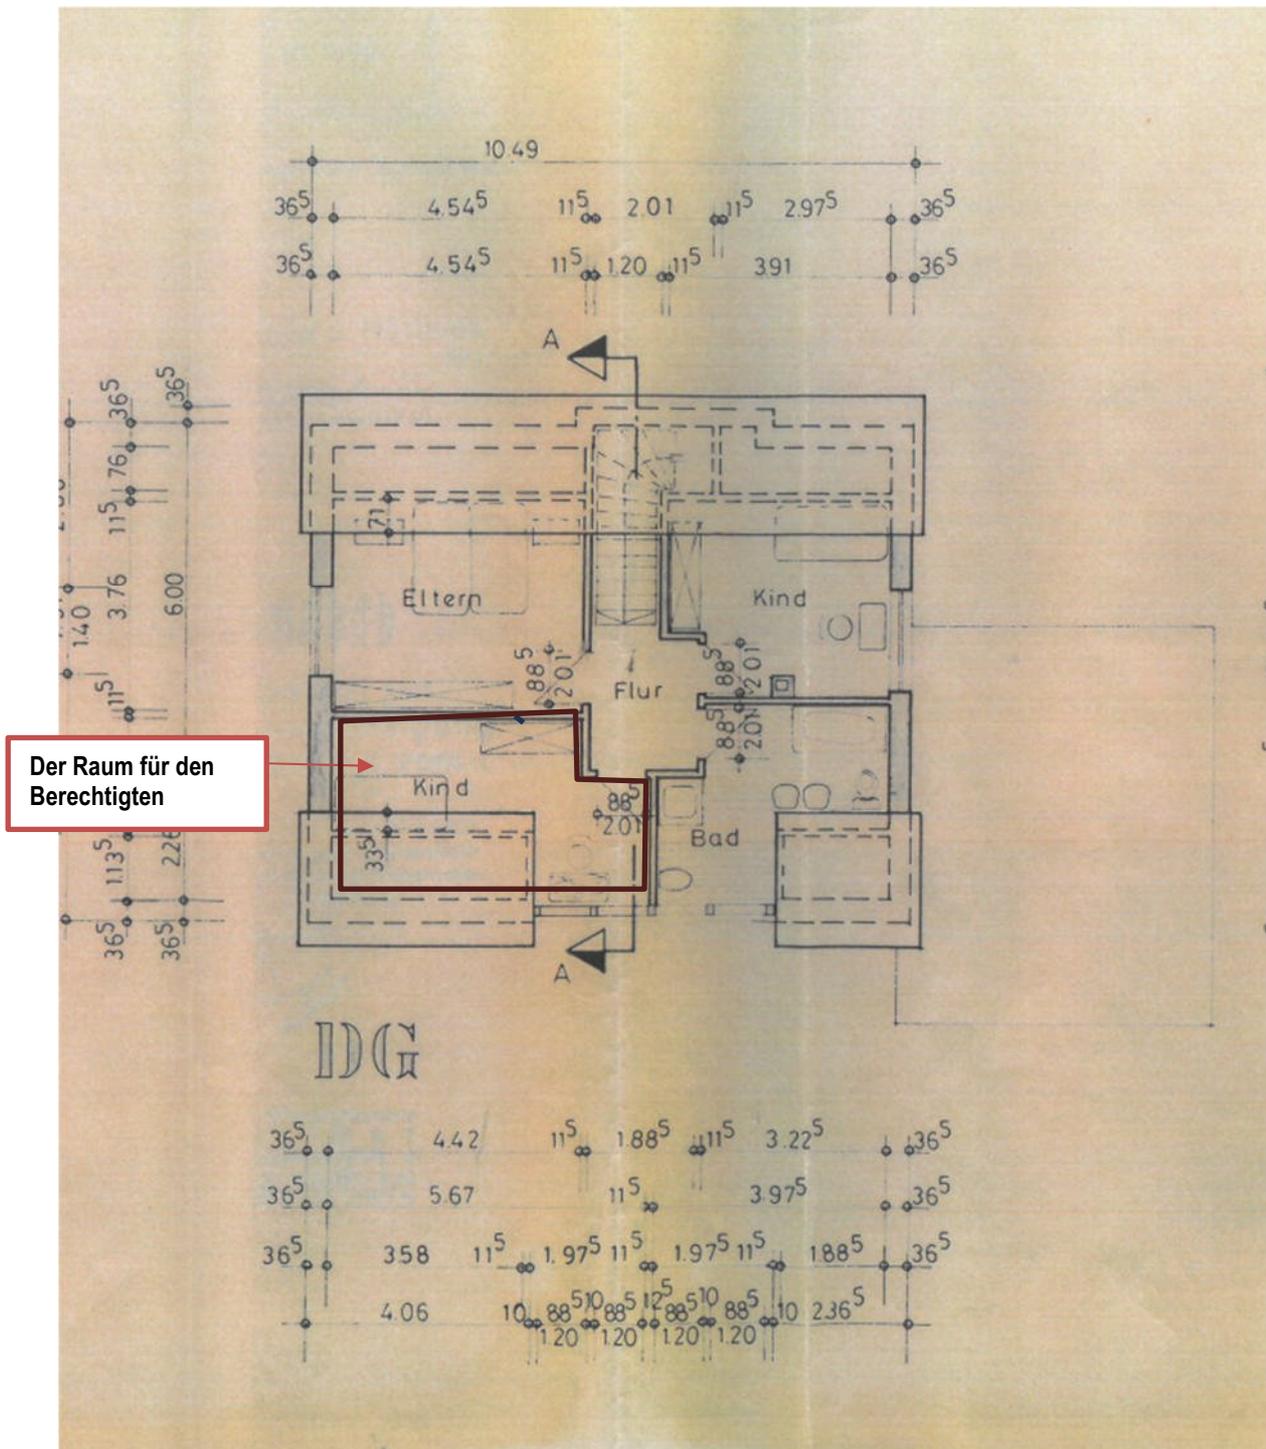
Dachgeschoss / Plan aus der Bauakte Abweichungen sind möglich
